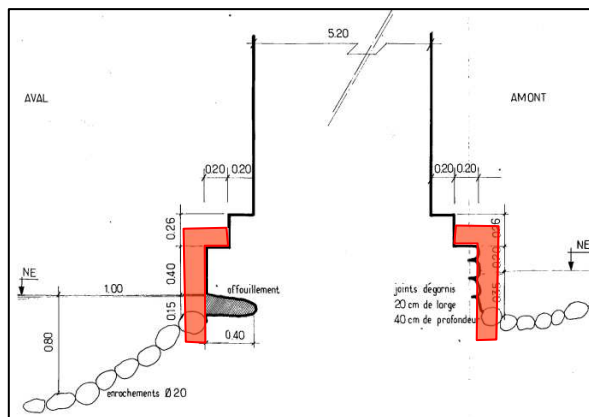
Coupe longitudinale de la pile 1 – Source : Document de visite avant travaux d'élargissement
